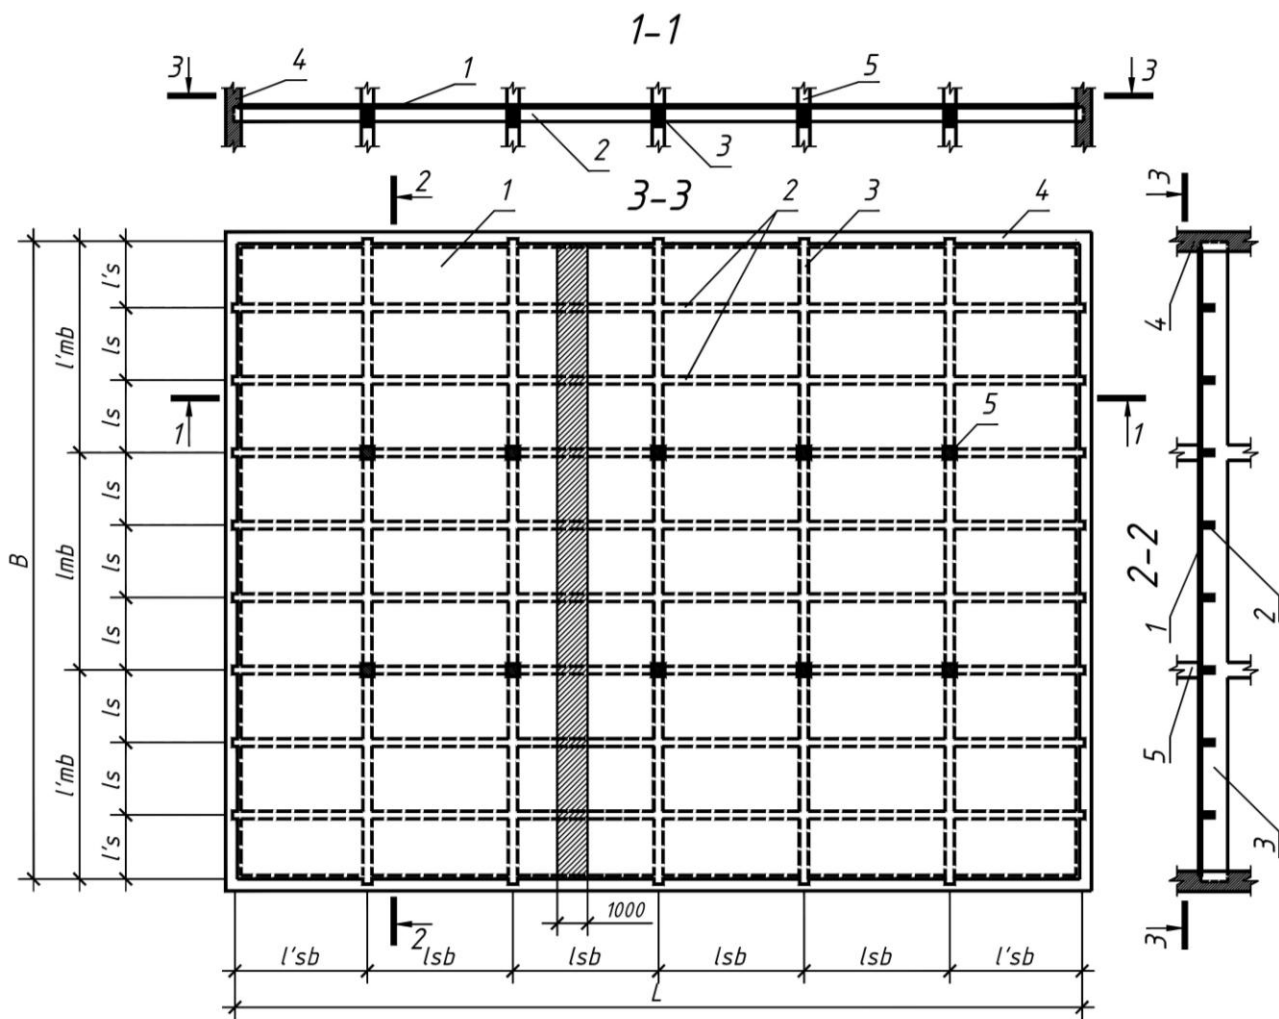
План монолітного ребристого перекриття з головними балками впоперек будівлі: 1 – плита; 2 – другорядна балка; 3 – головна балка; 4 – стіна; 5 – колона
